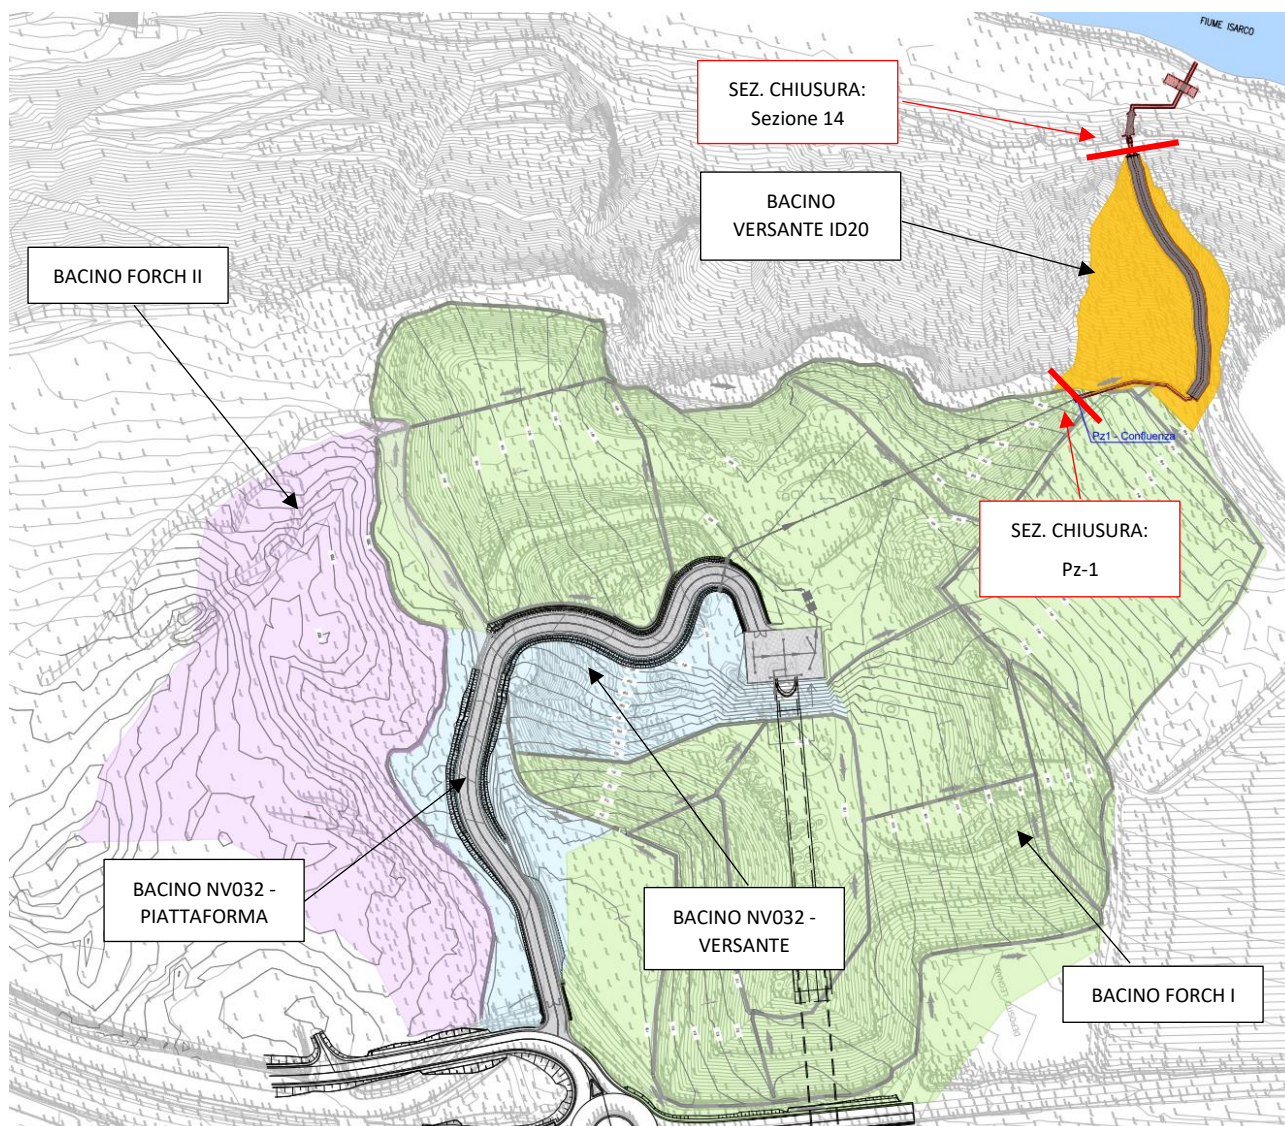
Stralcio planimetrico della corografia dei bacini drenanti
